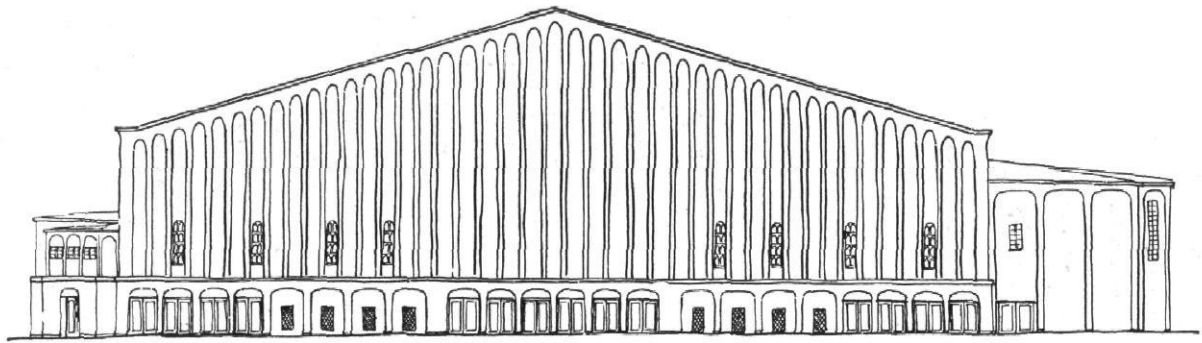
/ Großes Schauspielhaus Berlin. Umbau von Hans Poelzig
